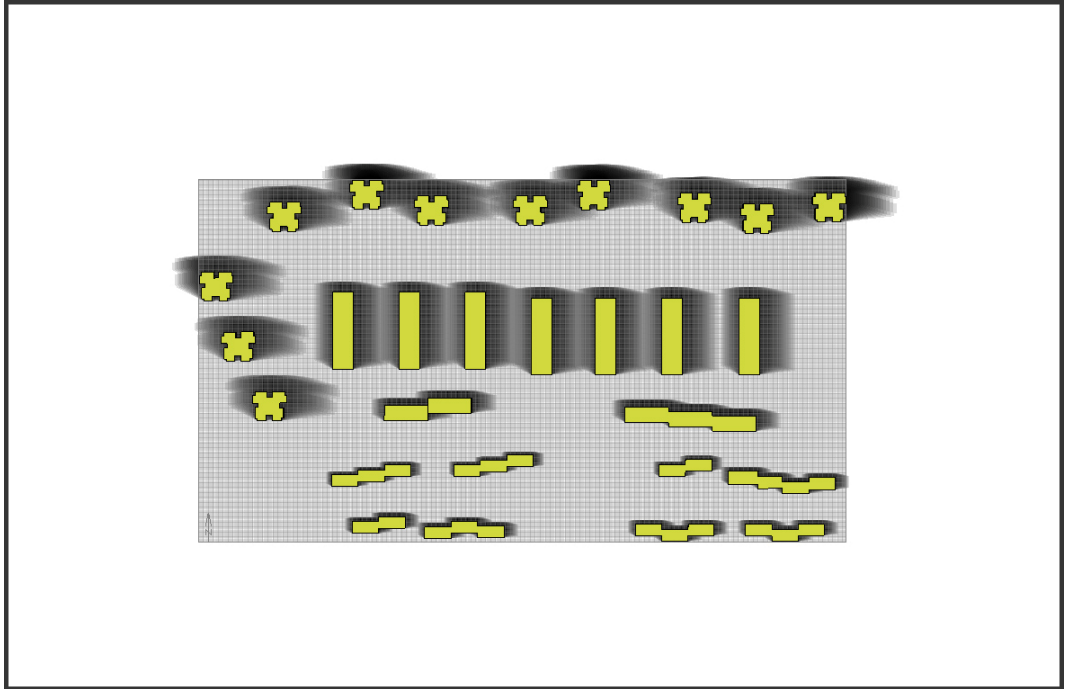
Ataköy 5. Kısım öneri vaziyet planı 1
